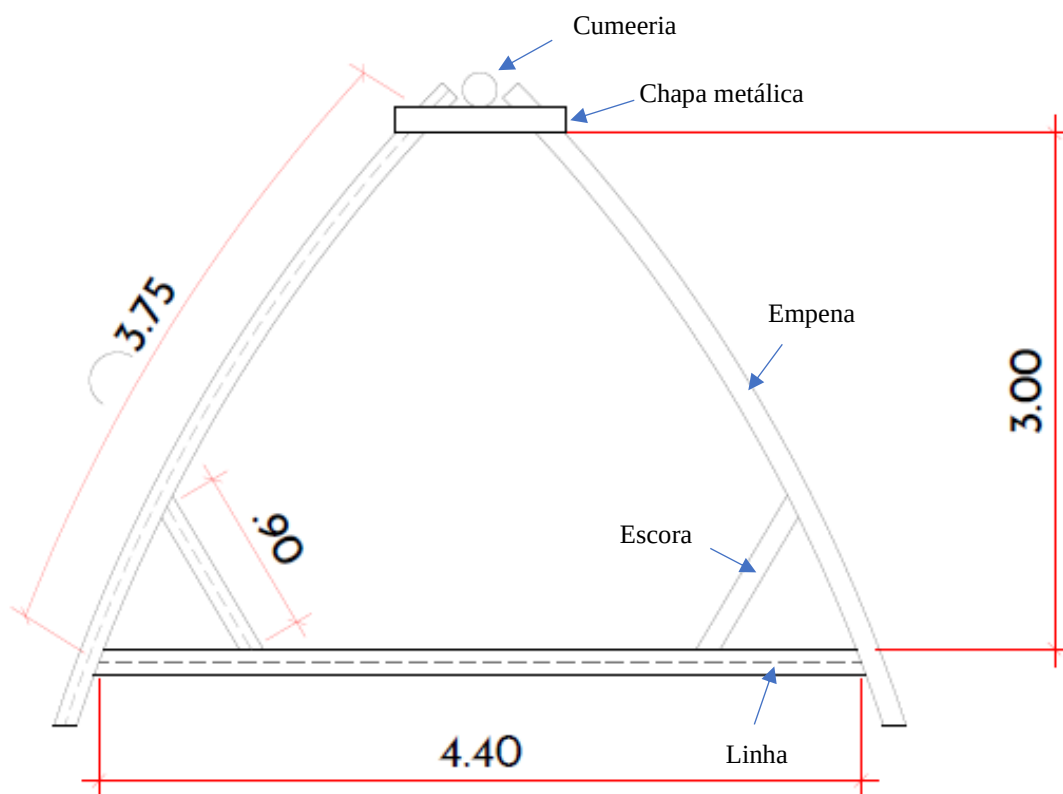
Detalhe maquete estrutura "Whale Bone"
